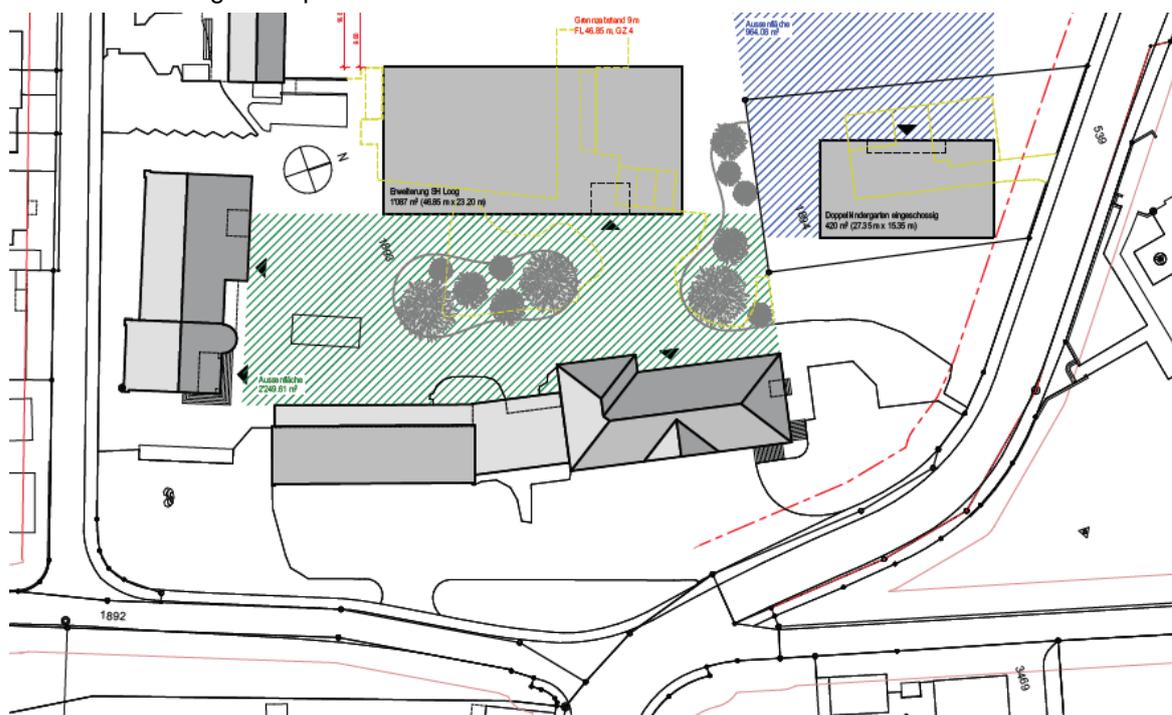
Situierung möglicher Neubau Schulhaus und Doppelkindergarten (Quelle: Baureag Architekten)
